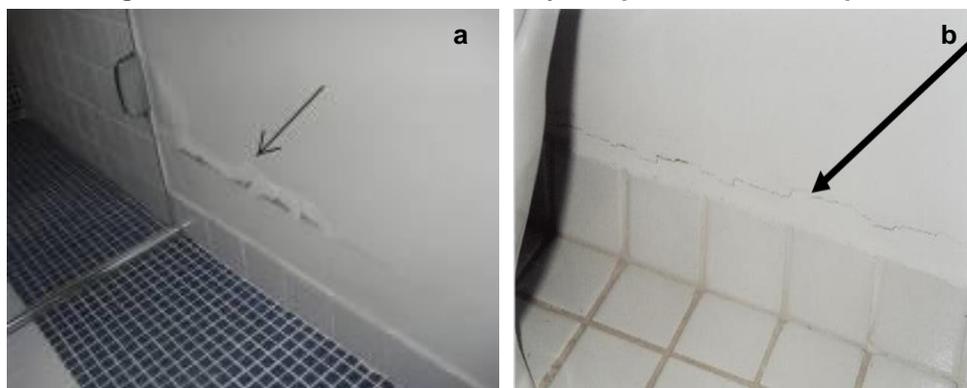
Trincas e fissuras no encontro de chapas de gesso acartonado ou azulejos
